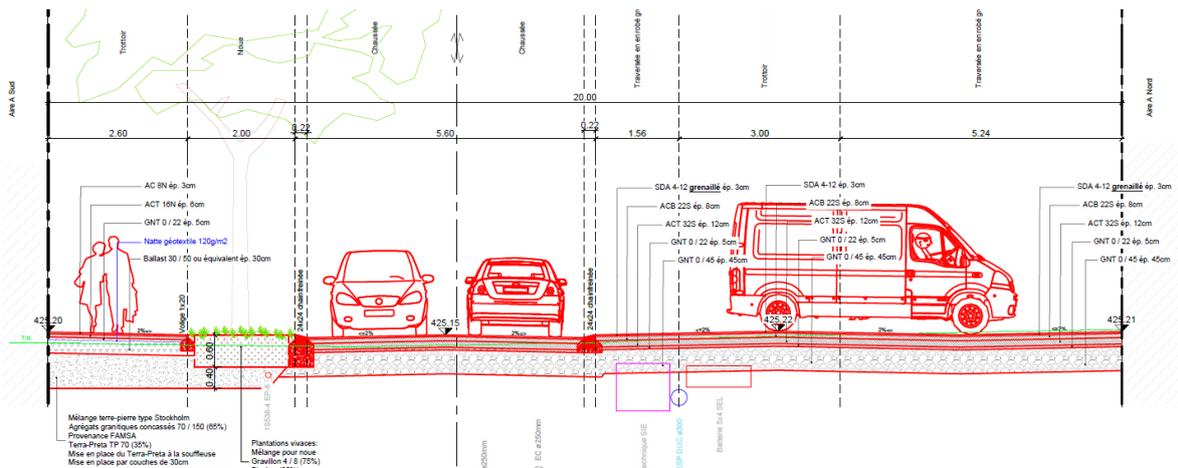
Profil type du tronçon 1 sur entrée garage Malley-Gare, Groupement Mhust, 2022
